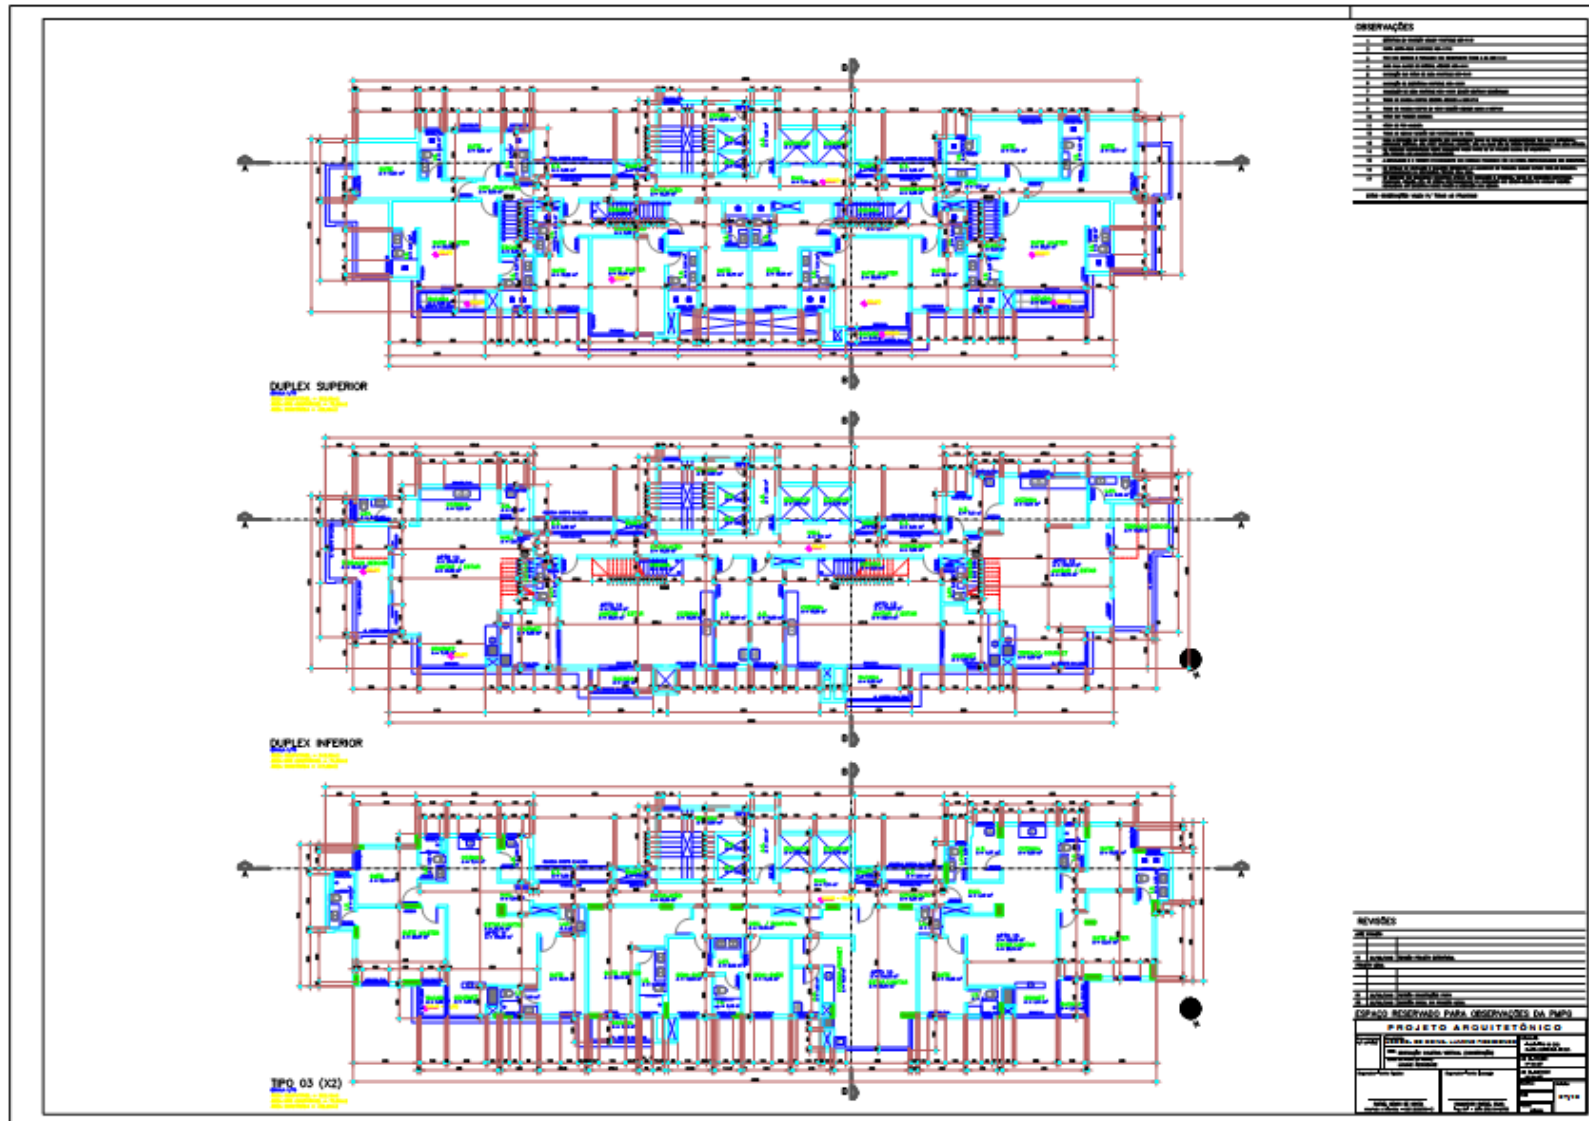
Planta Tipo 3 (x2), duplex pavimento inferior e duplex pavimento superior.
